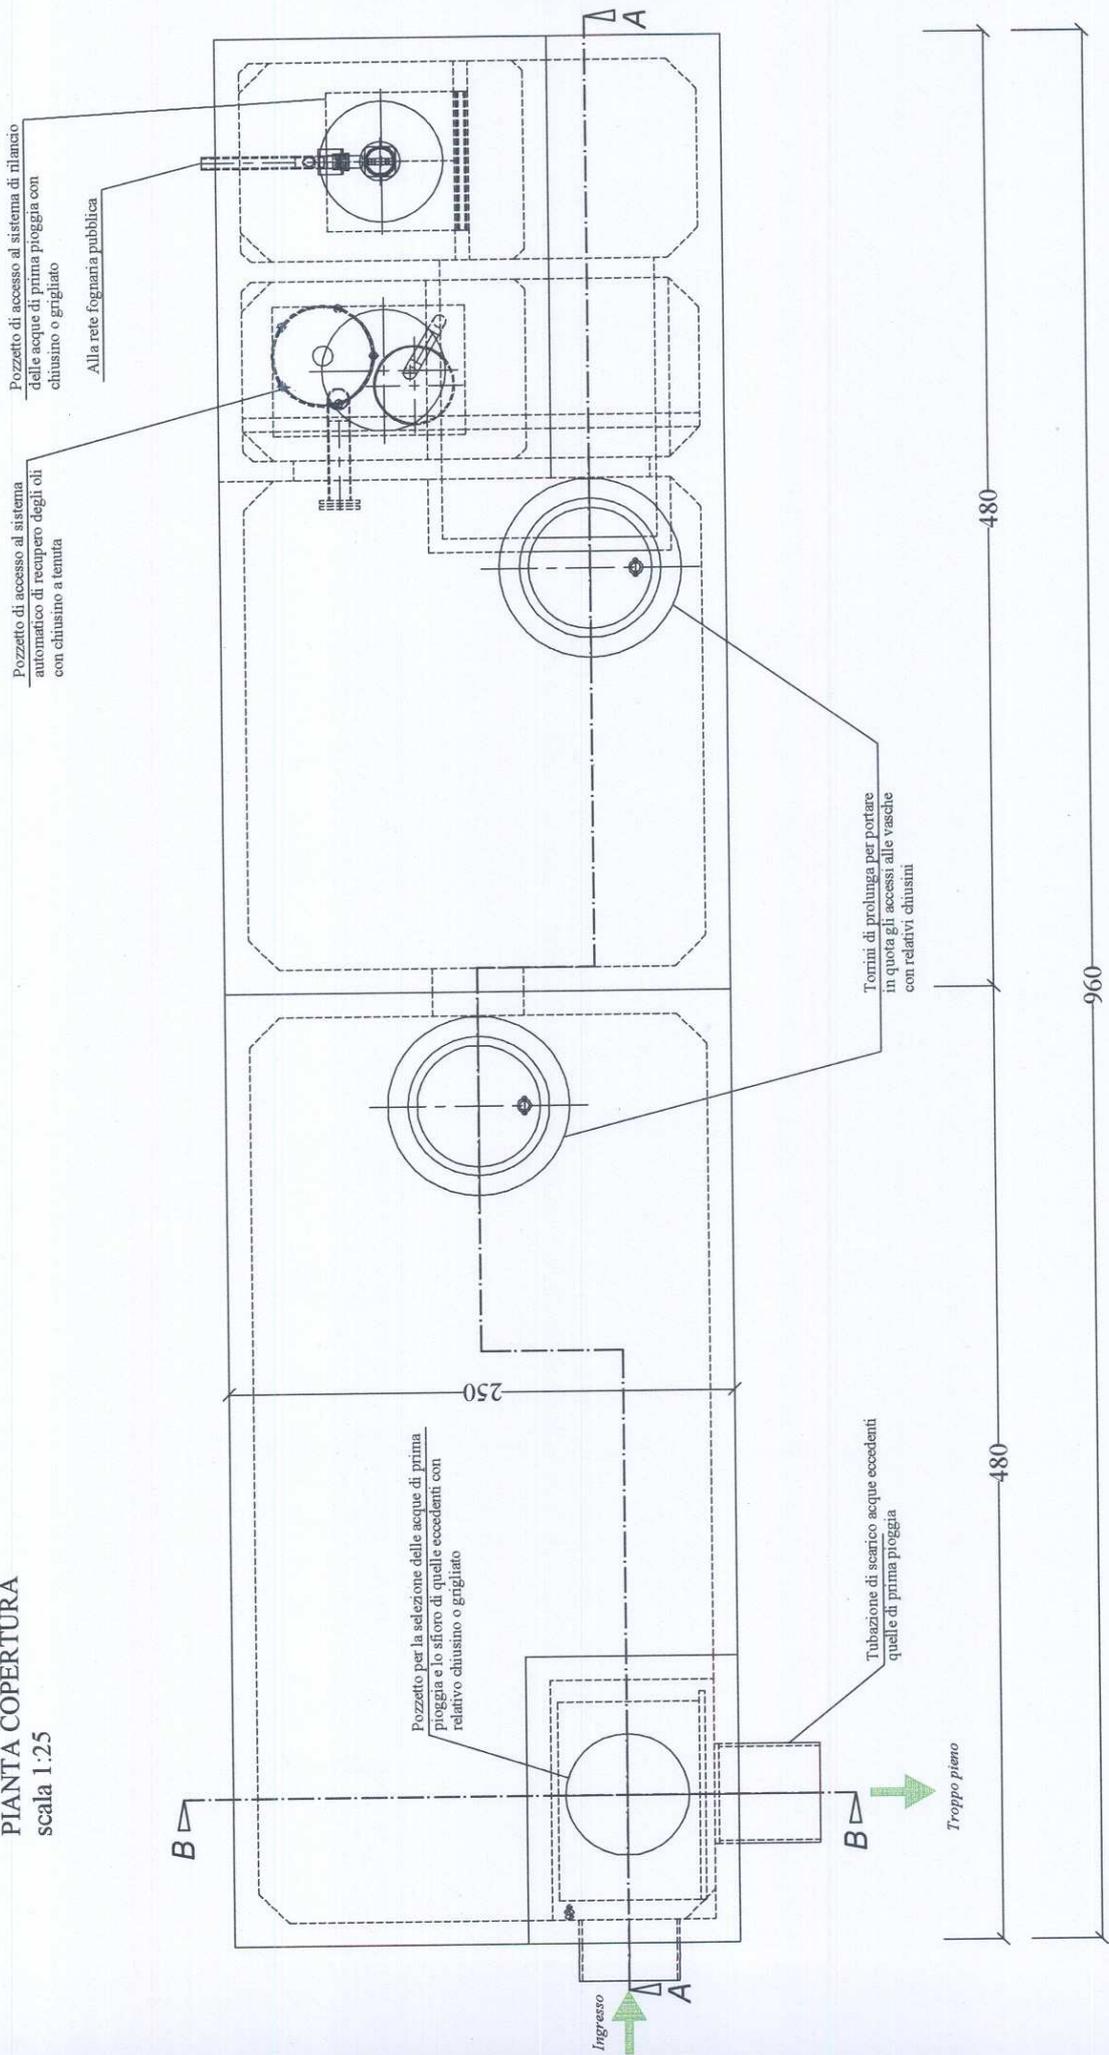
Planimetria rete di smaltimento delle acque meteoriche
